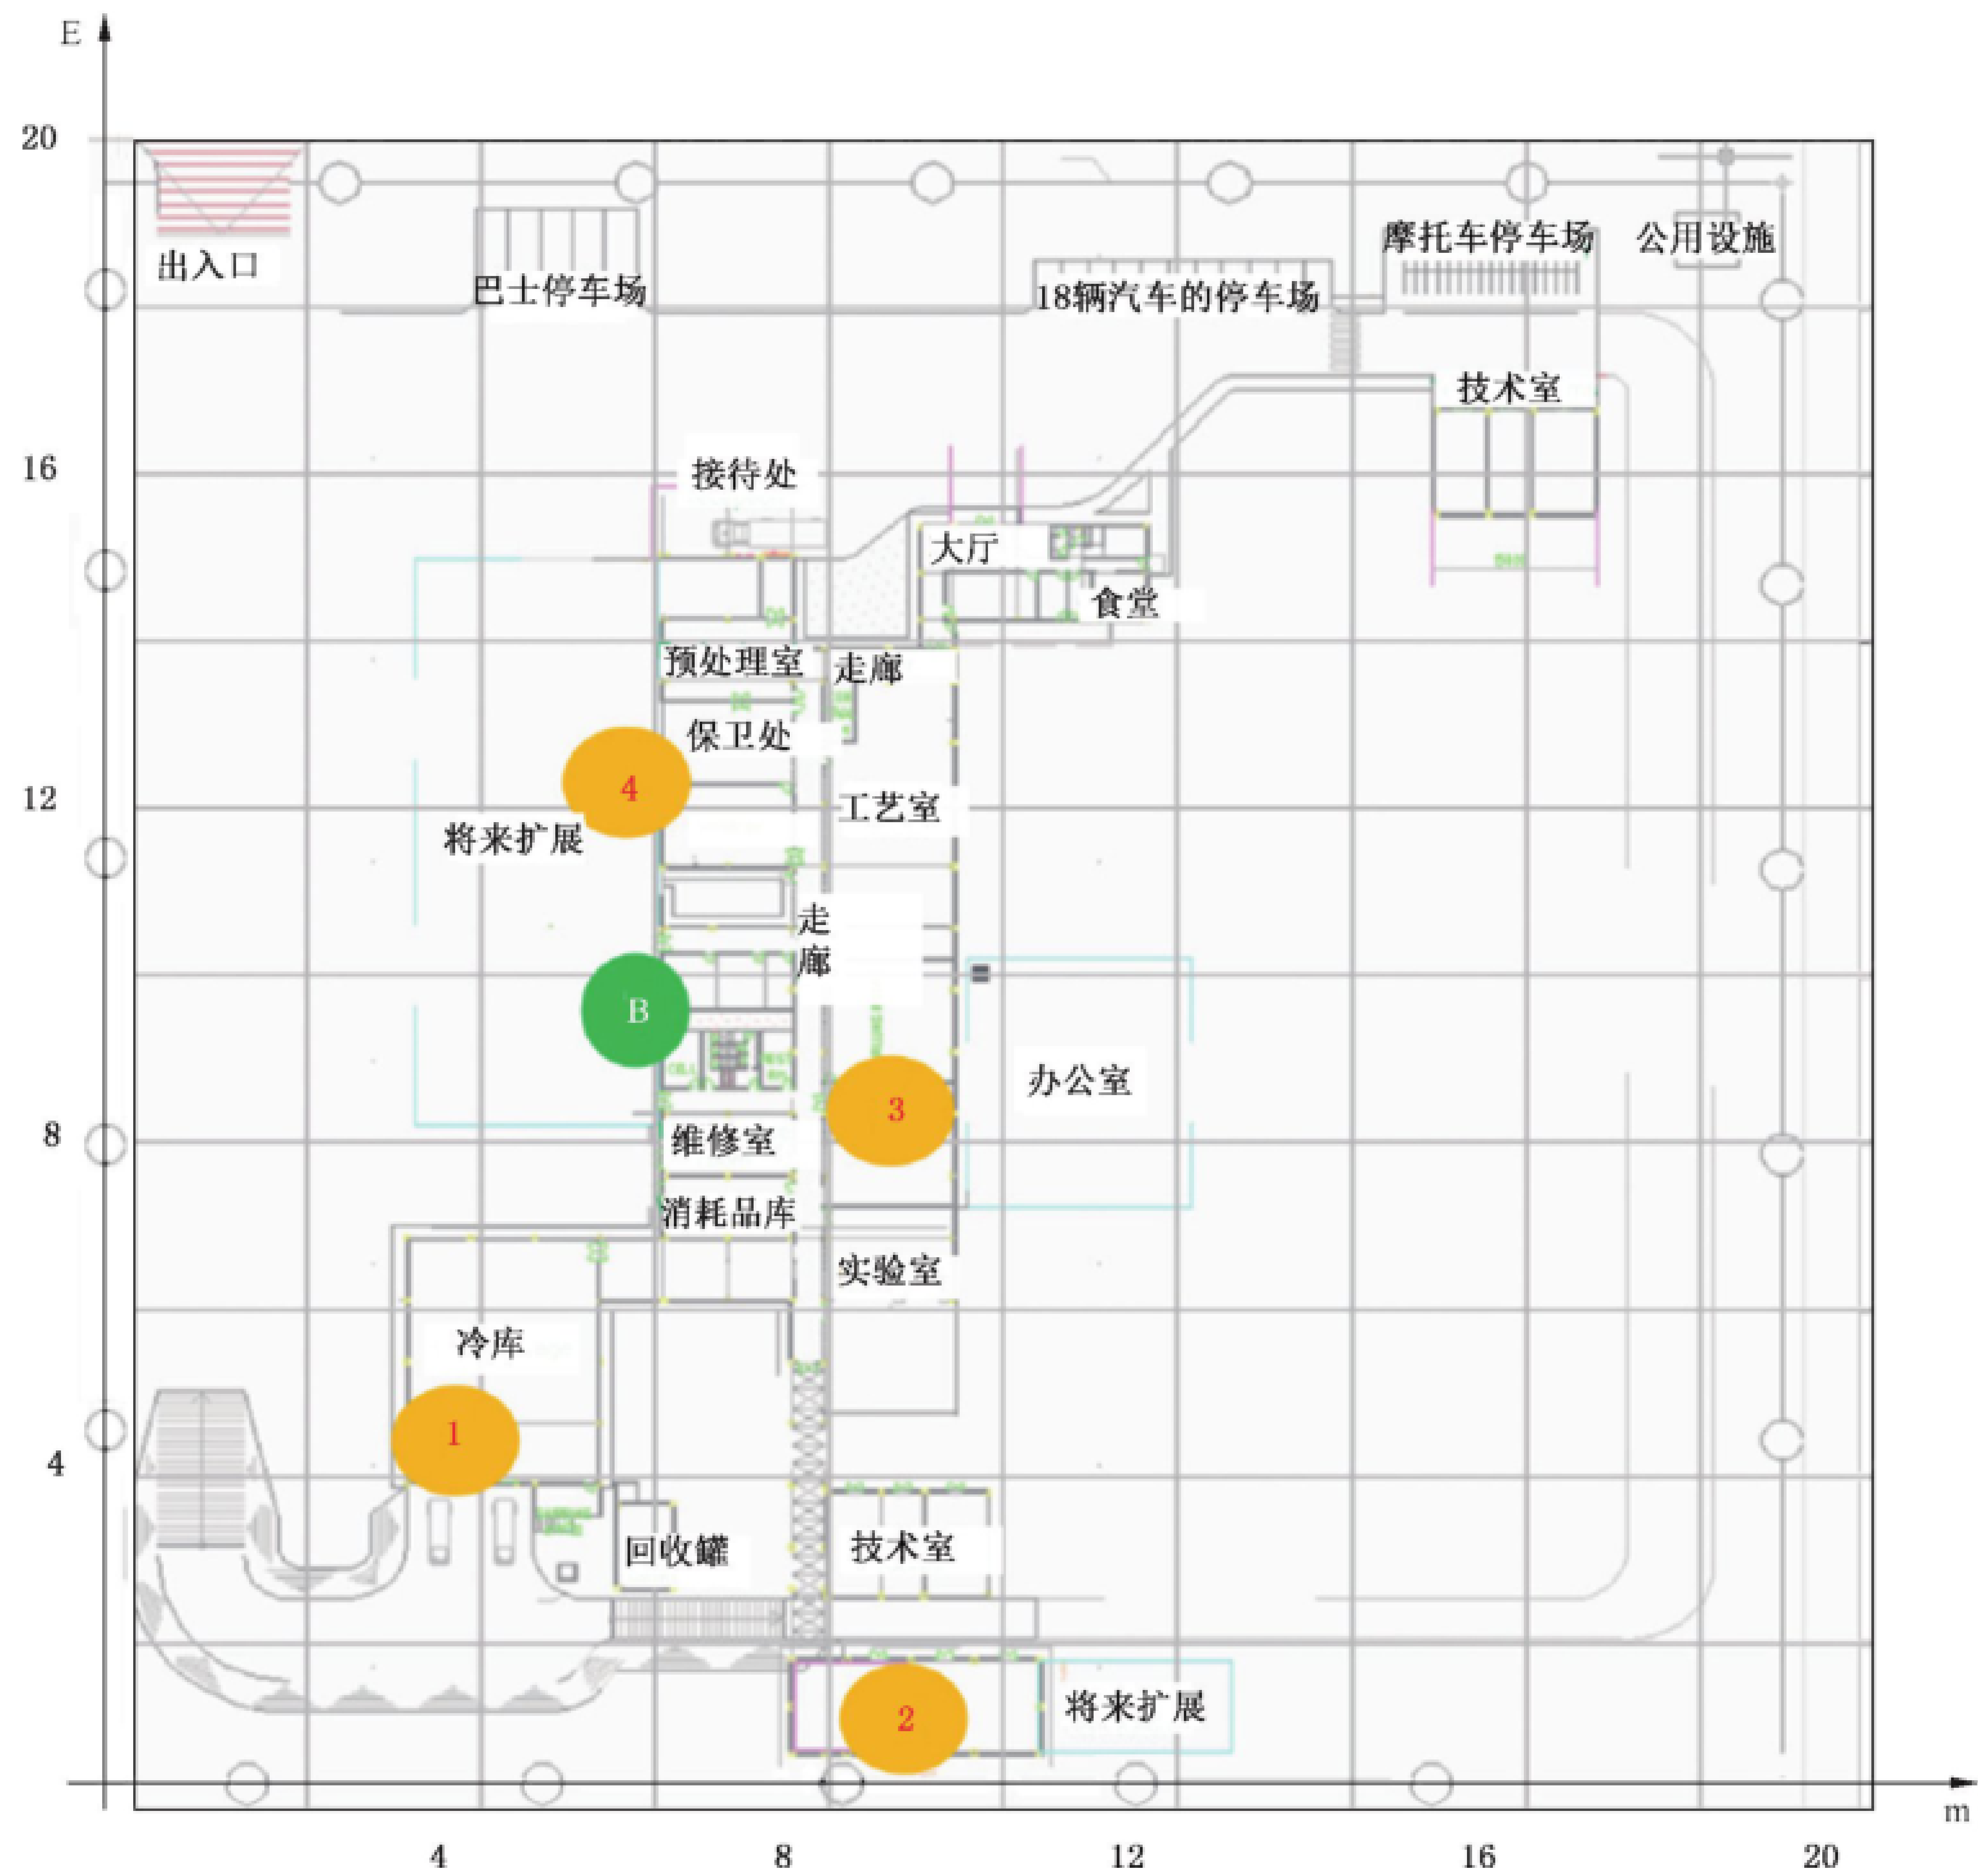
示例 1:具有计划负荷和计算重心的某生产厂平面图
